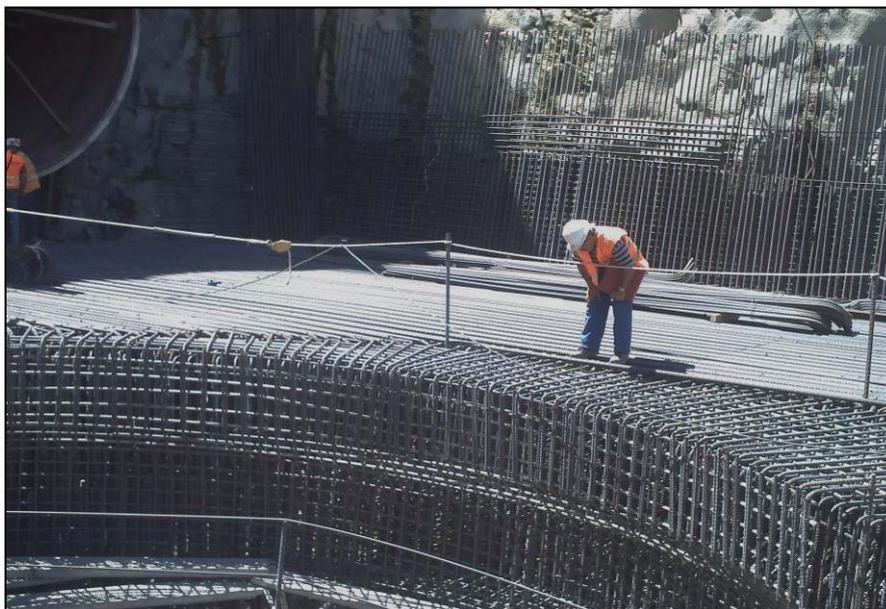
Central. Grupo 1. Armadura superior da metade Norte da laje do difusor
